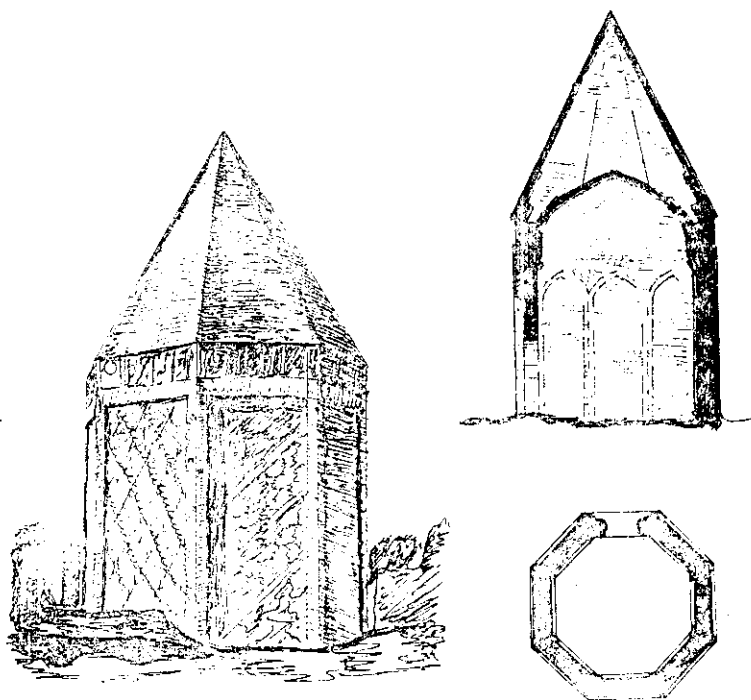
Усыпальница ходжи Юсуфа Хамадаи, общий вид, разрез и план
